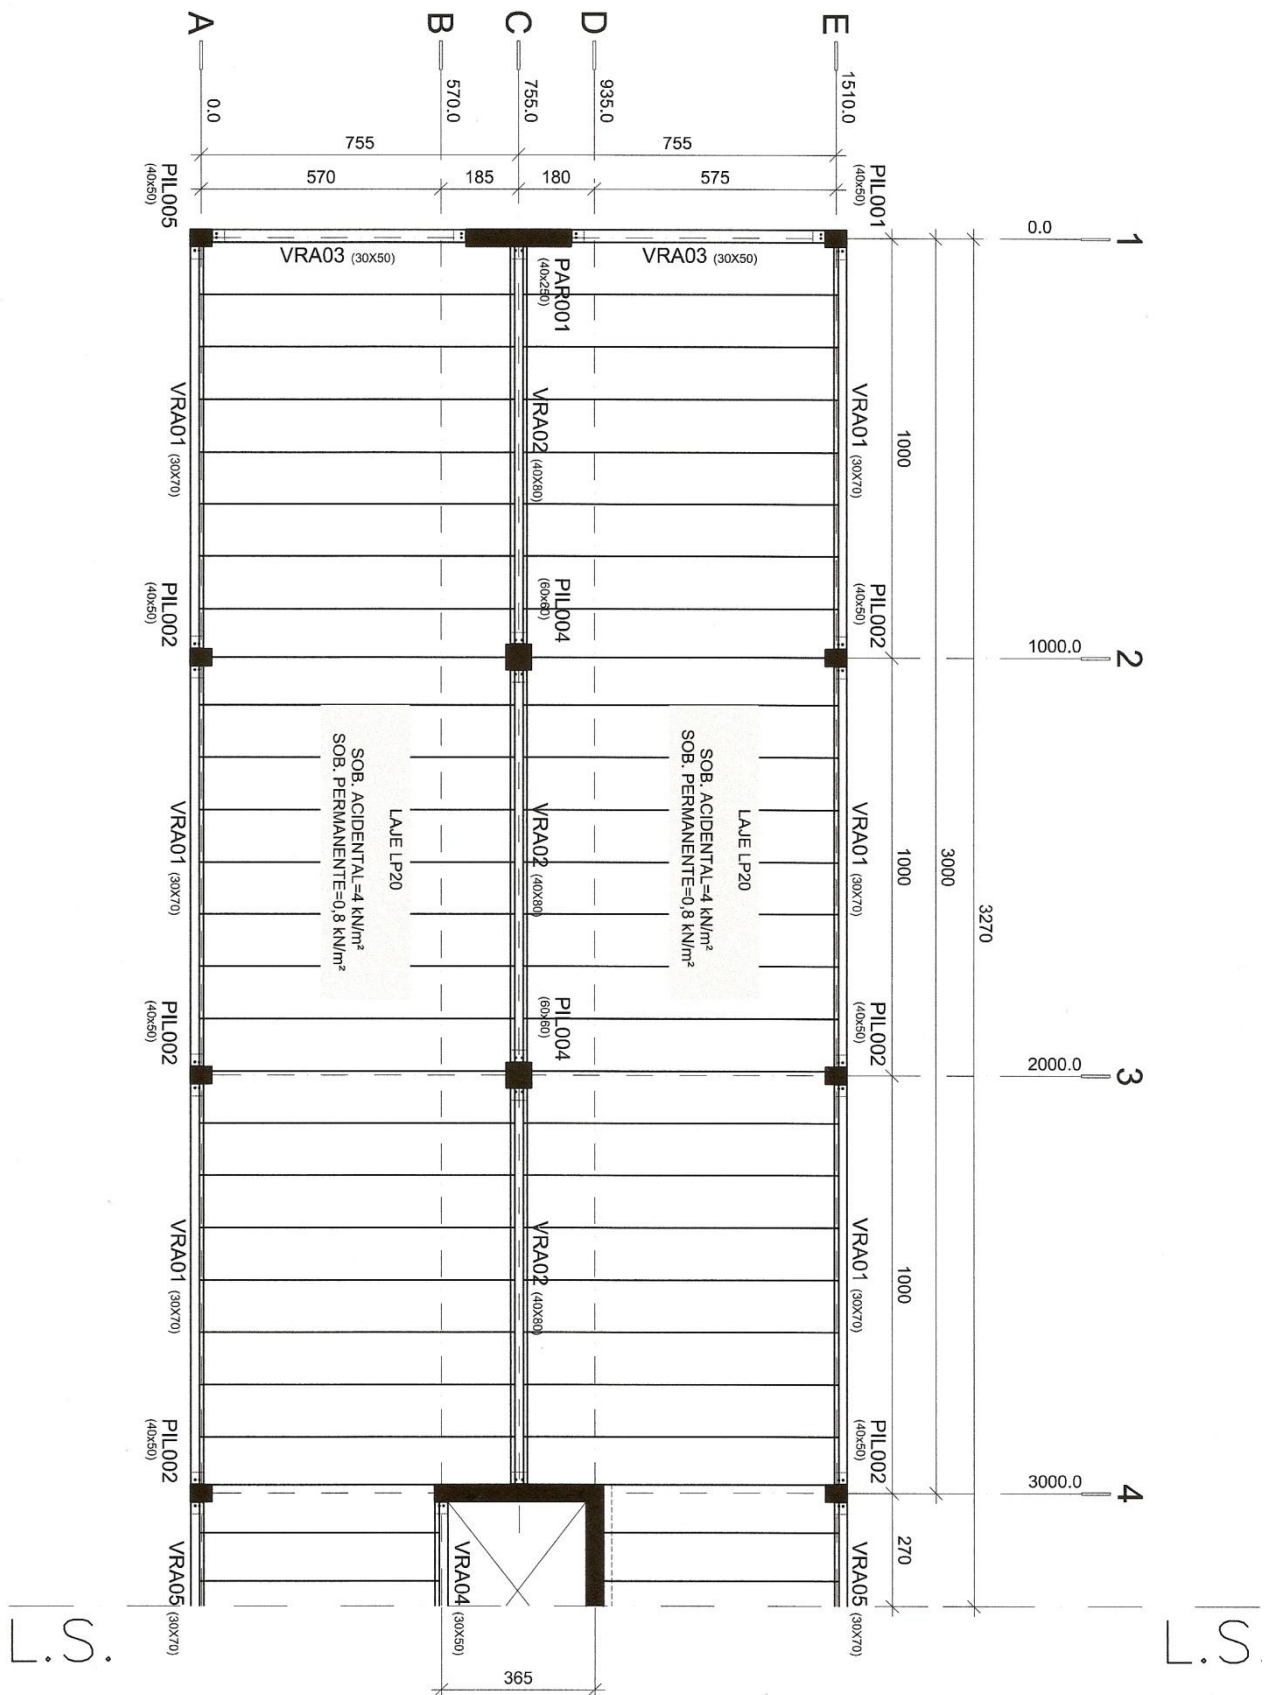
2 – Pavimento tipo da estrutura a ser analisada neste exemplo.
